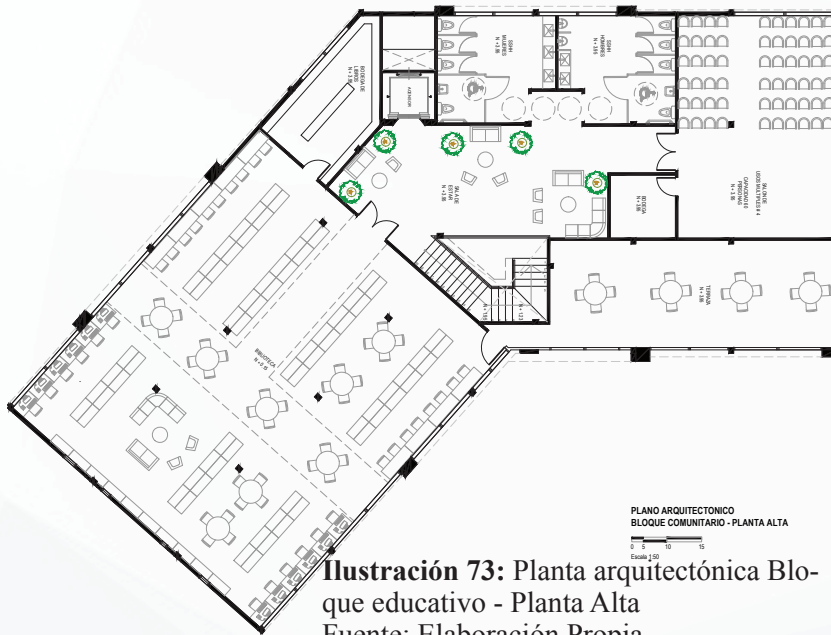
Planta arquitectónica Bloque educativo - Planta Alta
